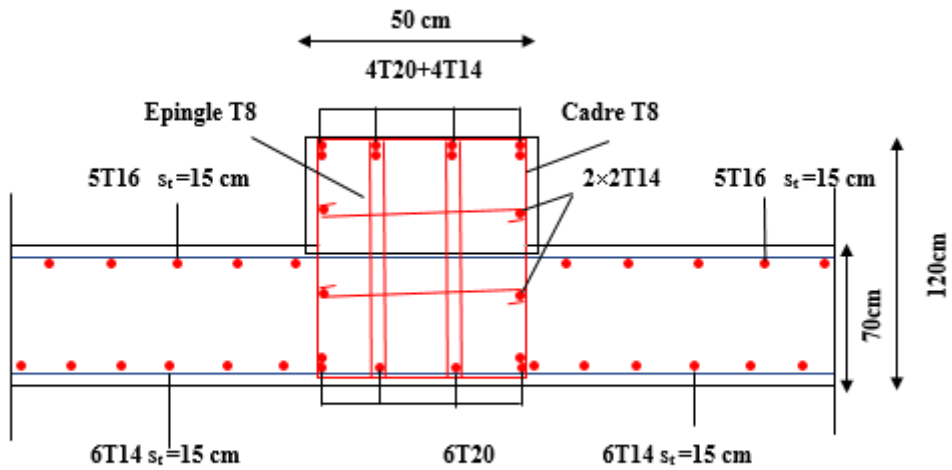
Ferrailage des nervures sens Y sur appui.
